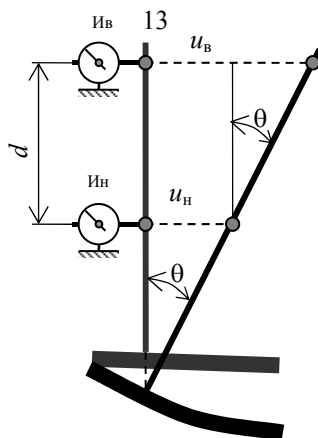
Схема, поясняющая вычисление угла поворота сечения балки
